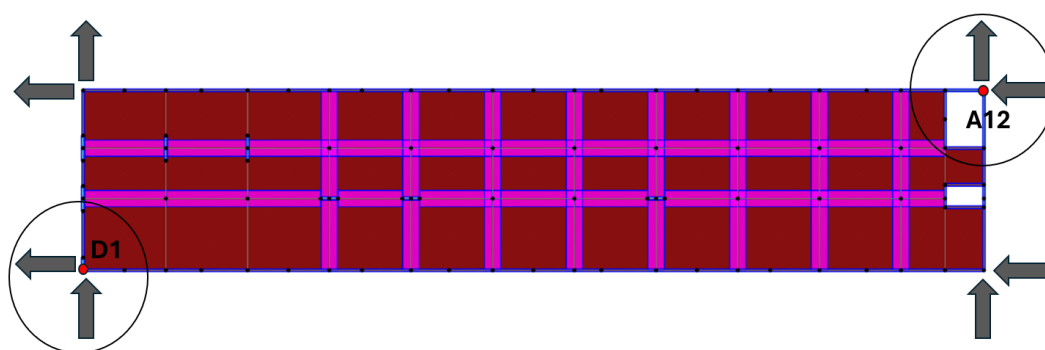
Pavimento rígido no plano XY(Z=0) do modelo computacional utilizado
